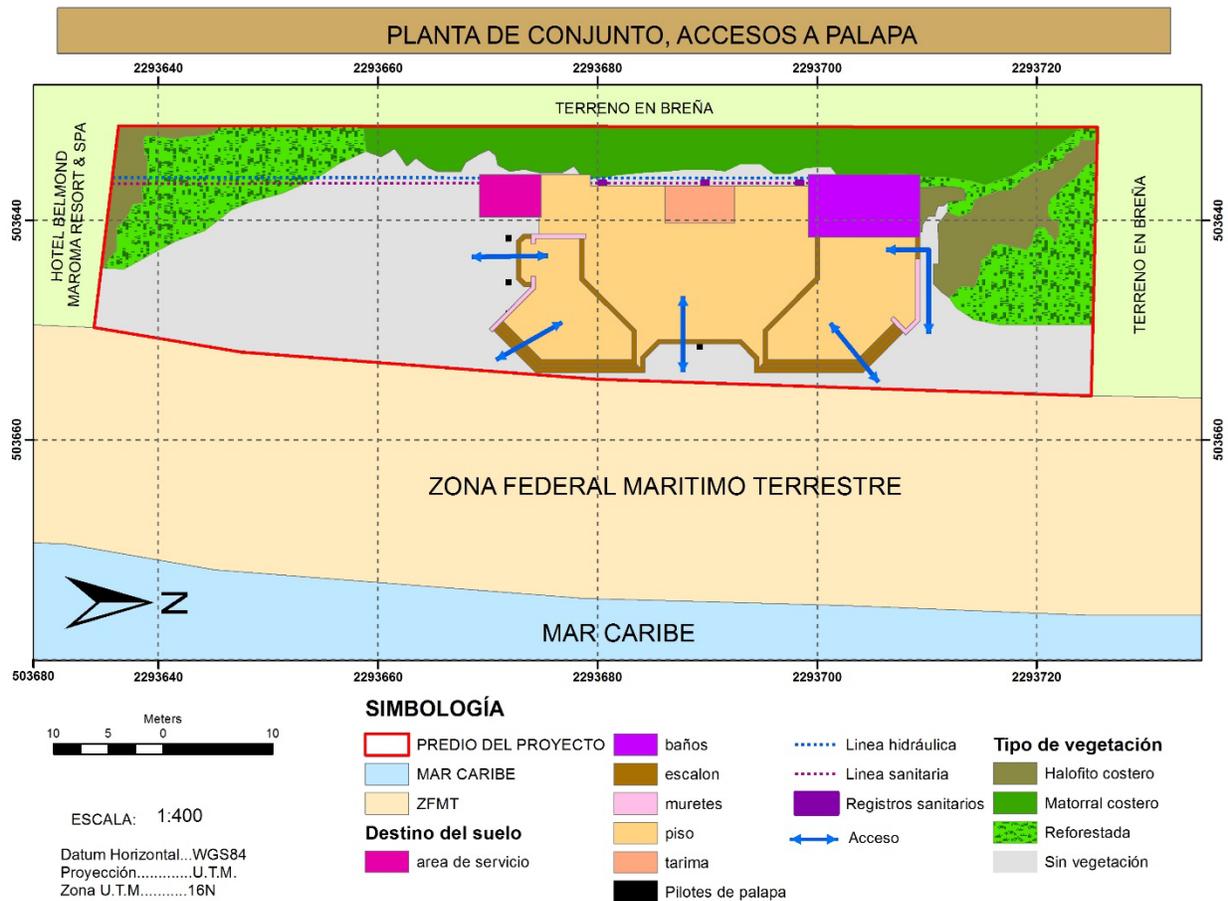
Planta conjunto del proyecto terminado, donde se aprecian los accesos destinados a la palapa proyectada. Fuente: Promovente.
